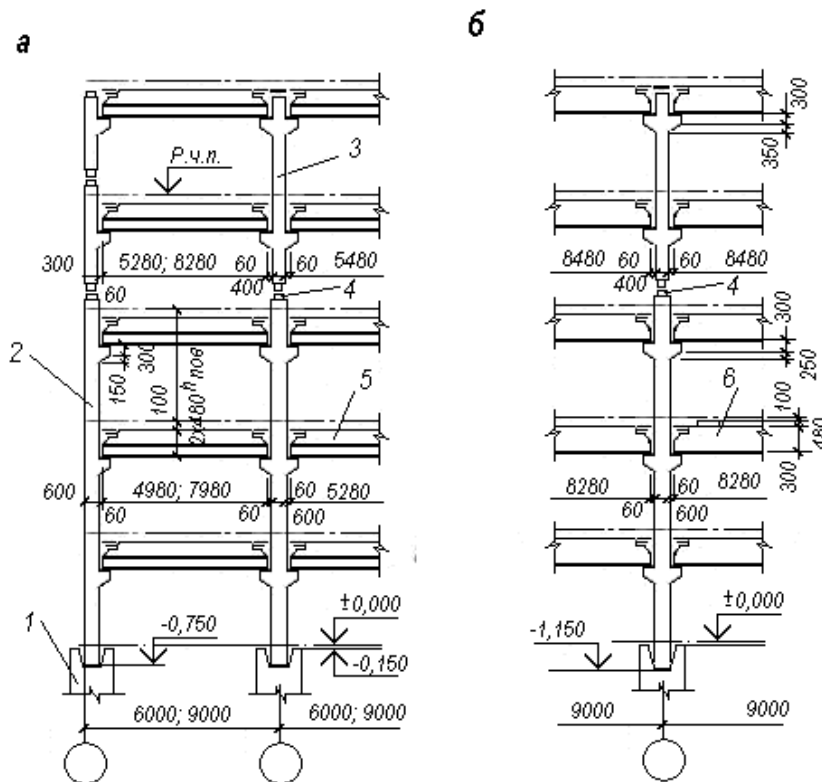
Балковий каркас багатоповерхової виробничої будівлі: а – ригелі з полицками; б – ригелі без полицок (обпирання плити зверху); 1 – фундамент; 2 – крайня колона; 3 – середня колона; 4 – стик колони; 5 – ригель з полицками для обпирання плит; 6 – ригель без полицок
